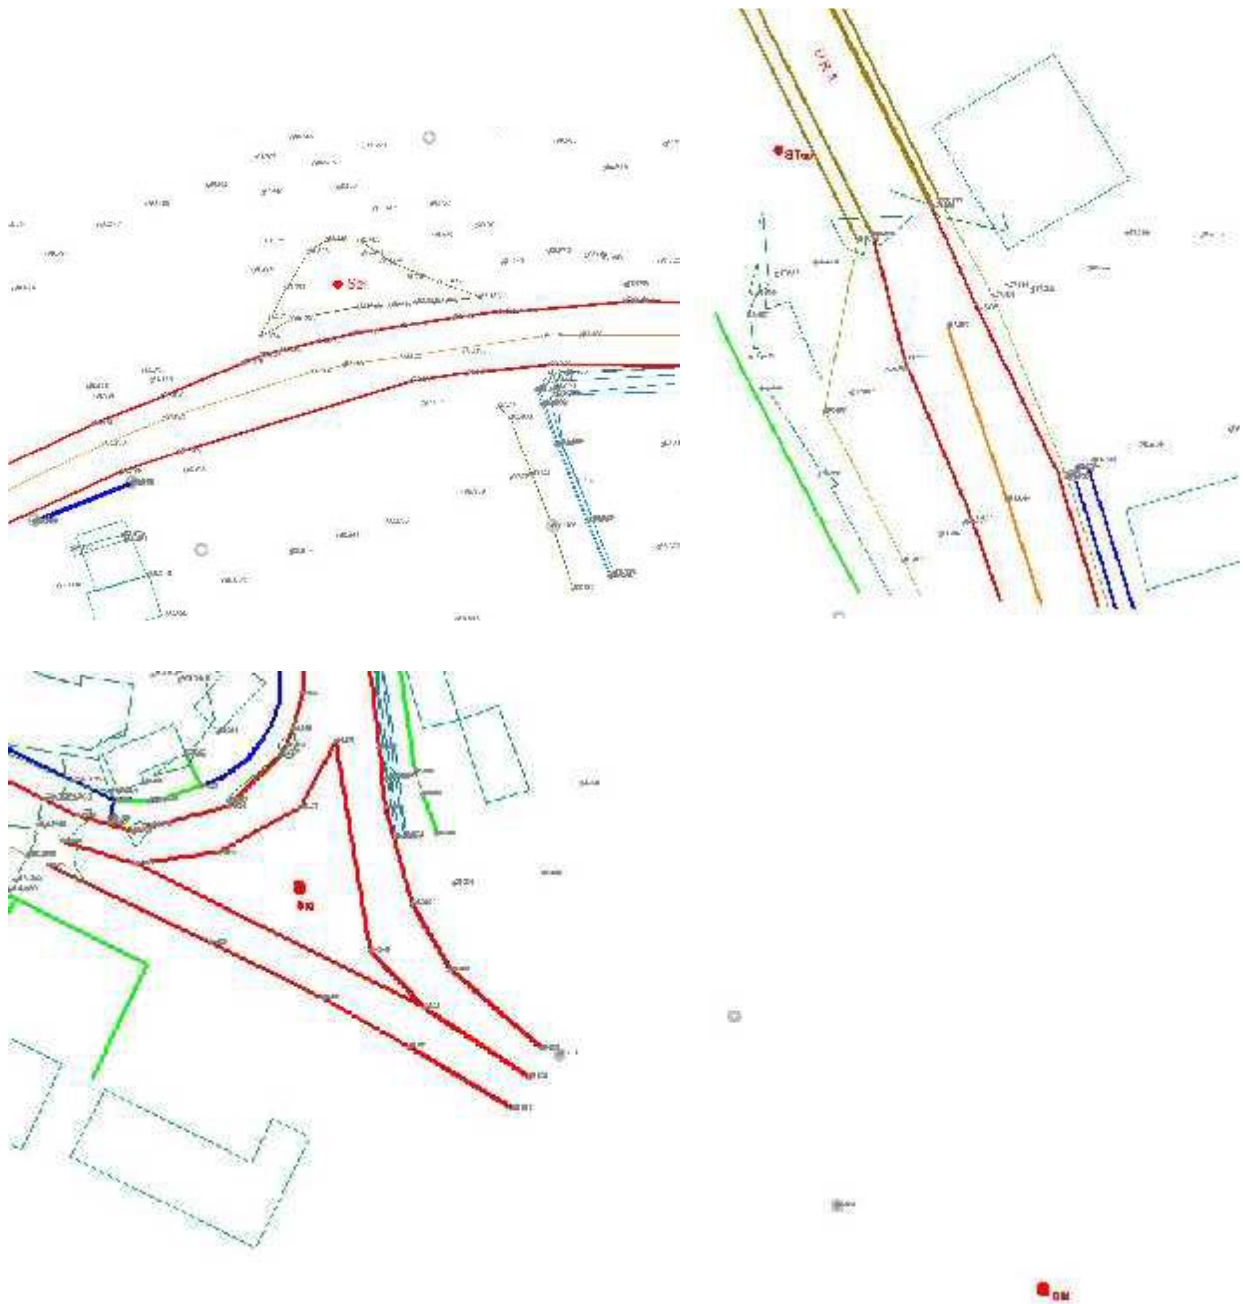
Pozicioni në planimetri i pikave ST21, ST60, ST10 dhe ST11
